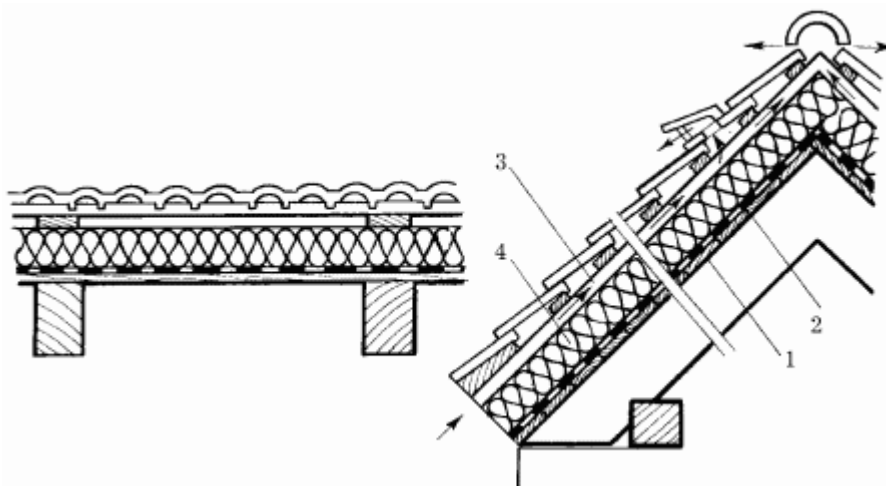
Изоляция на стропилах: 1 – обшивка; 2 – защитный слой; 3 – контрбрус; 4 – теплоизоляция.
